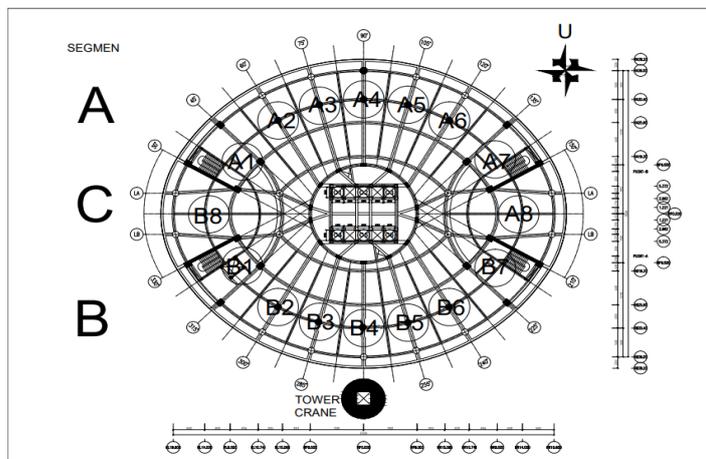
Denah Pekerjaan Pengecoran Dengan Concrete Pump Lantai 11
